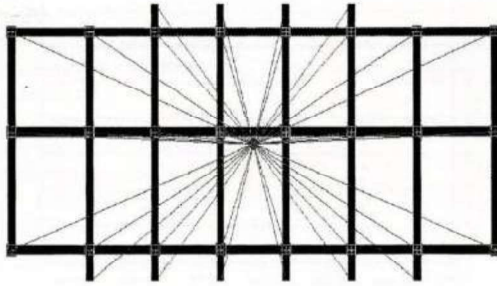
Modélisation plancher rigide- plancher flexible (structure en portique)
